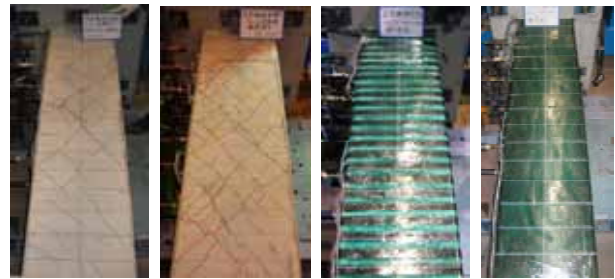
補修前のひび割れ発生状況 (a : No.5, b : No.6) と CFRP 補強後供試体 (c : No.4, d : No.7)
